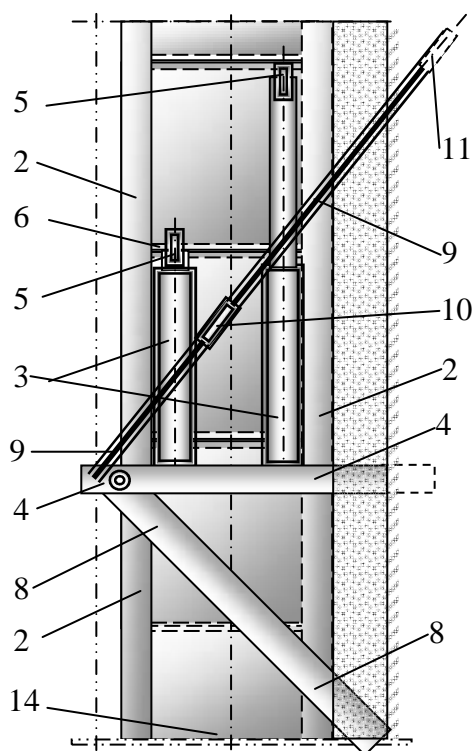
Продольное сечение ствола с гидродомкратным подъемом
